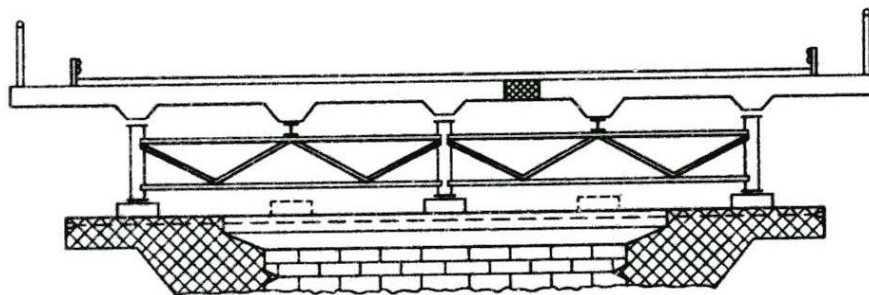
Схемы расширения металлических пролетных строений
